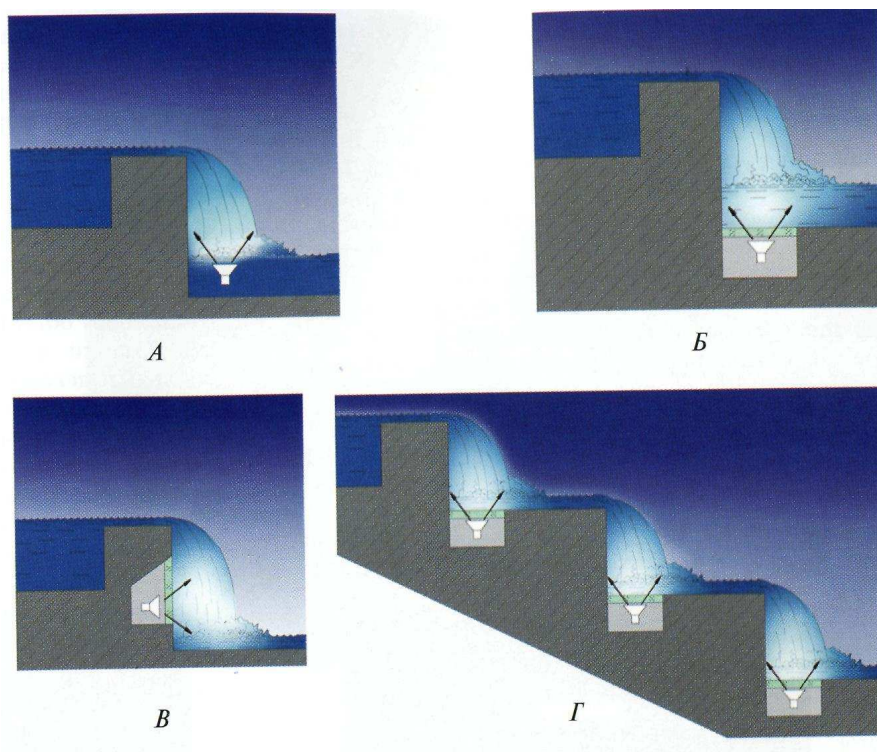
Размещение ОП для освещения водных переливов: А – освещение падающей воды, ОП погружен в водоем; Б – расположение ОП в световой нише, перекрытой прозрачным упрощенным стеклом; В – освещение водяного перелива на «просвет»; Г – схема освещения водяных ступенек
